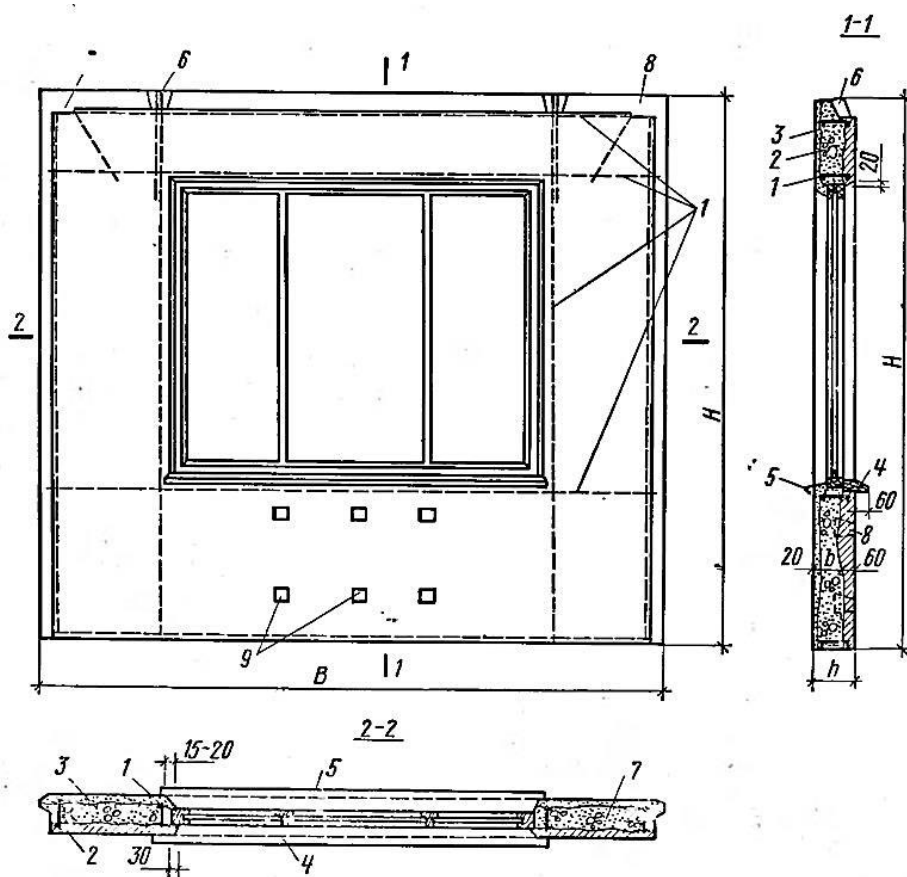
Пример конструкции двухслойной стеновой панели из лёгкого бетона:
